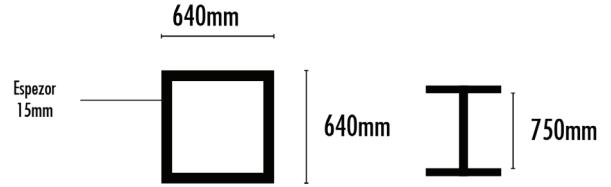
Predimensionamiento estructural del vano central y dobles alturas
